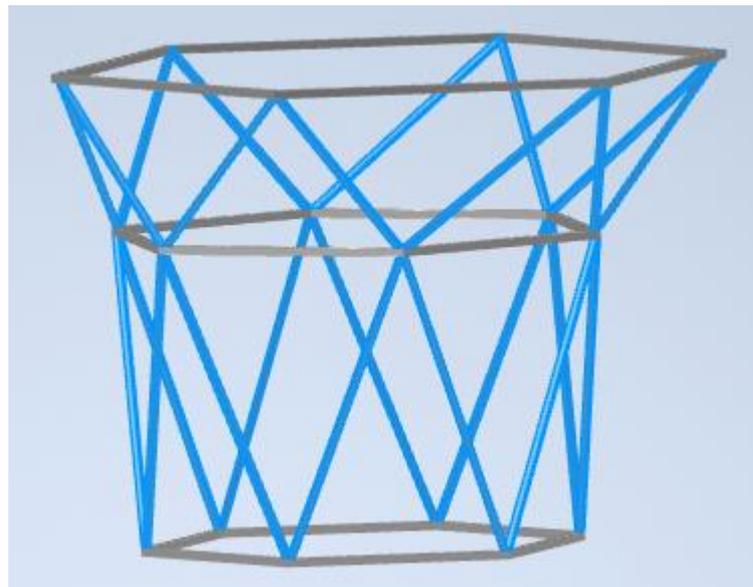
Perfiles 60 x 60 x 2,5 en la estructura
